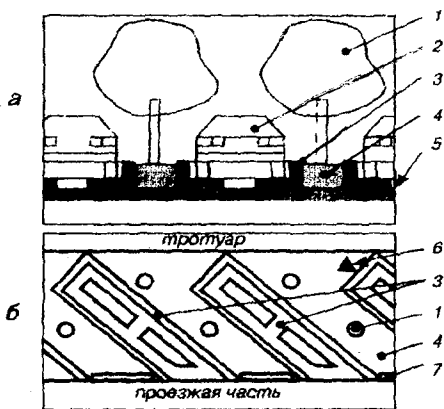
Схема парковки автомобилей на газонах с использованием специальных плит: а – поперечный разрез; б – вид в плане; 1 – деревья; 2 – запаркованный автомобиль; 3 – специальная железобетонная плита; 4 – газон; 5 – уровень ПЧ; 6 – возможное место установки паркометра; 7 – бортовой камень
